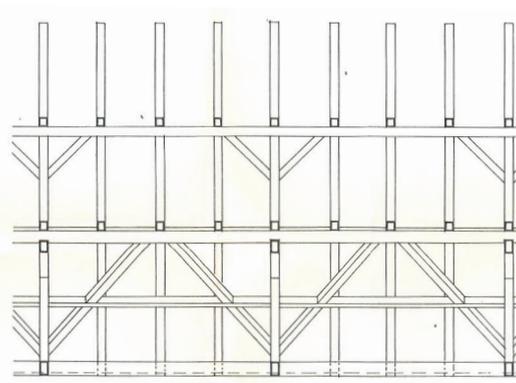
Längsschnitt Dachstuhl Hauptgebäude 1:50
